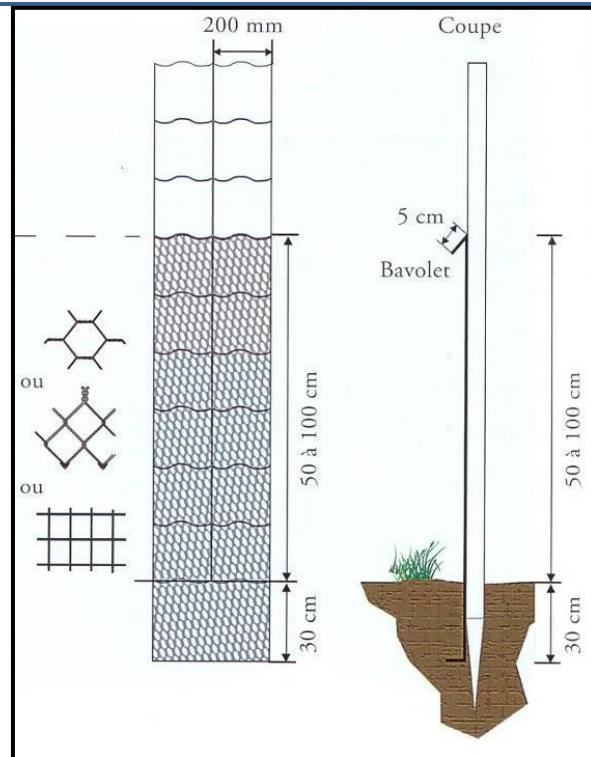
Grillage à petite section de type 6 (source : SETRA, 2005)
